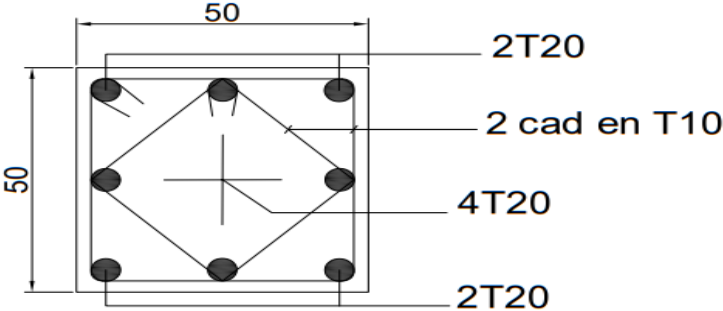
Schéma de ferrailage des poteaux de la 'ZONE 2'
